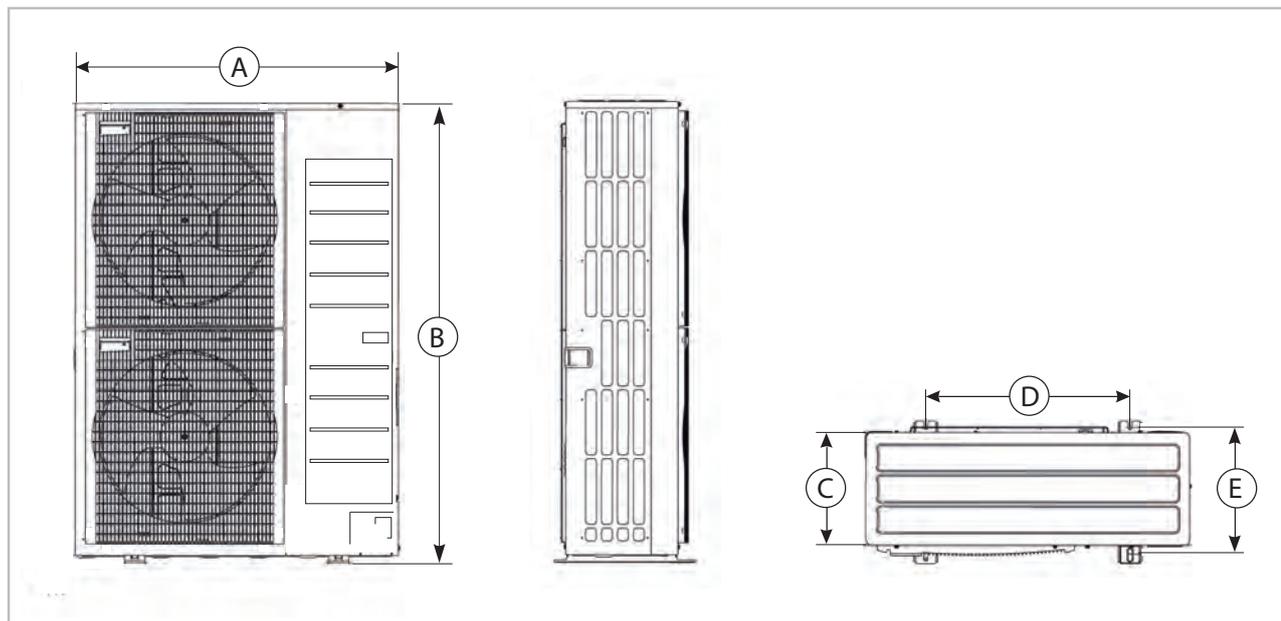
Dimensions du module externe WKF/ WKF-compact70/120/180
